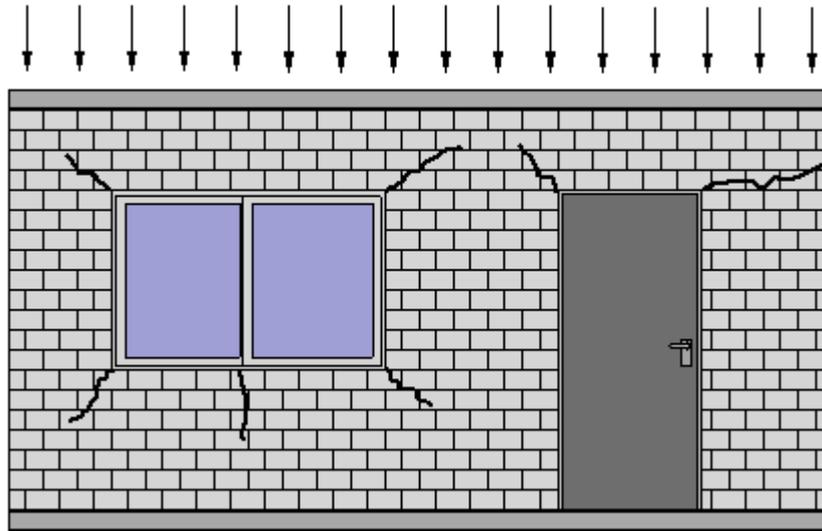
Fissuras oriundas de cargas concentradas.
